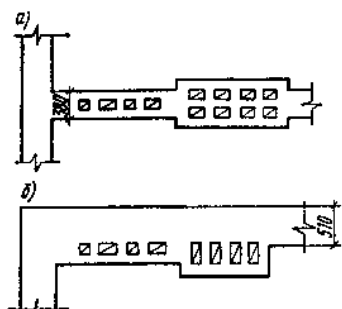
Расположение дымоходов: а – во внутренних стенах; б – в наружных стенах
